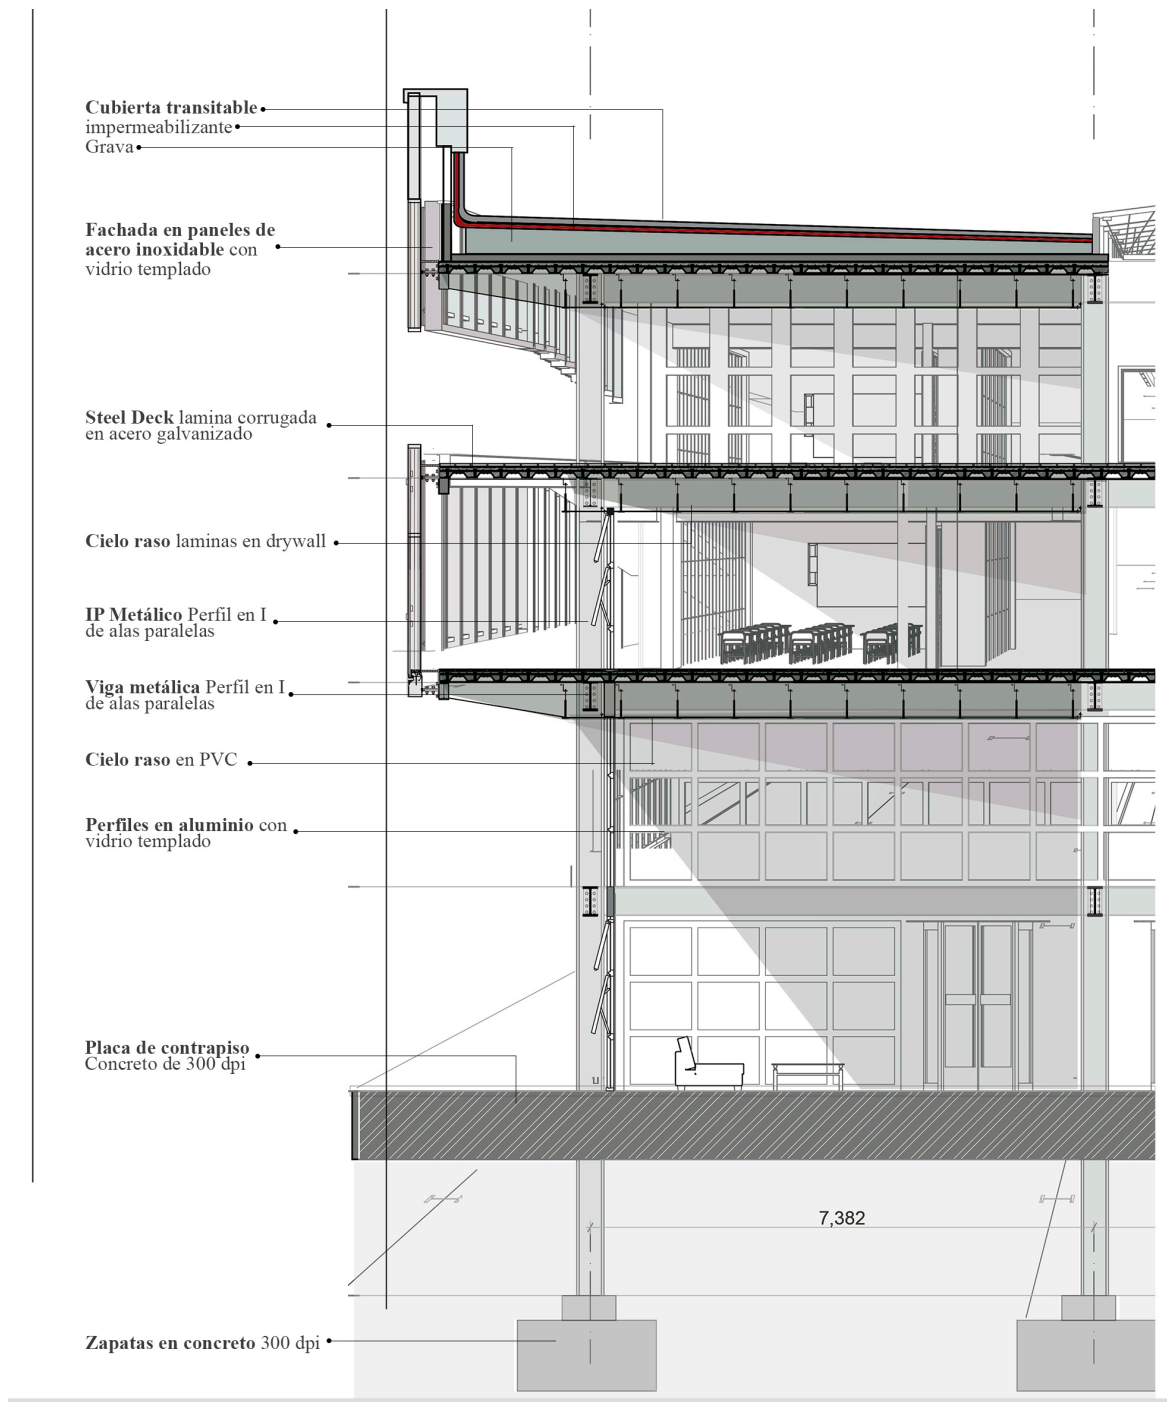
Corte Fachada. Fuente: Elaboración Propia
